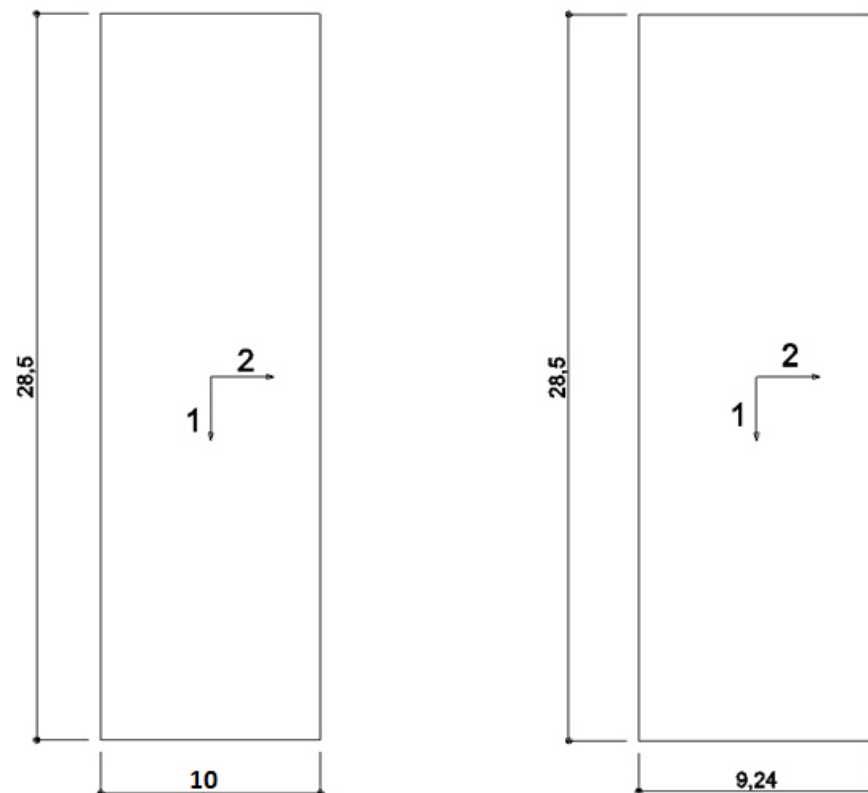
PLANTA DE LAS DIMENSIONES Y EJES DE LA ZAPATA 1 (IZQUIERDA) Y LA ZAPATA 2 (DERECHA)
